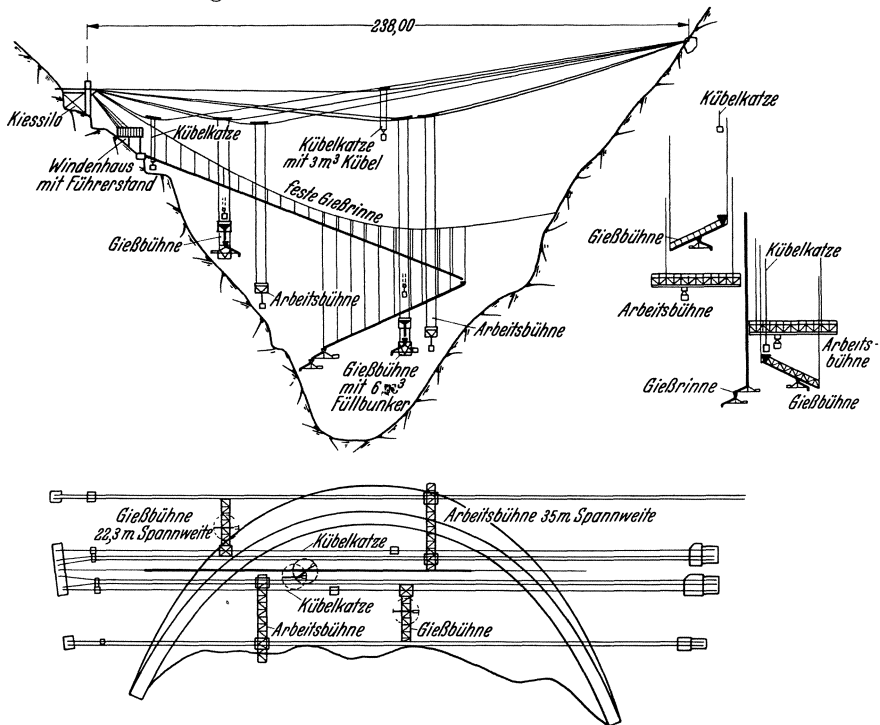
Betonierausrüstung für die Grimsel-Bogengewichts-Staumauer (Schweiz). Leistung 78 m³ Beton/h je Kabelkrananlage.
